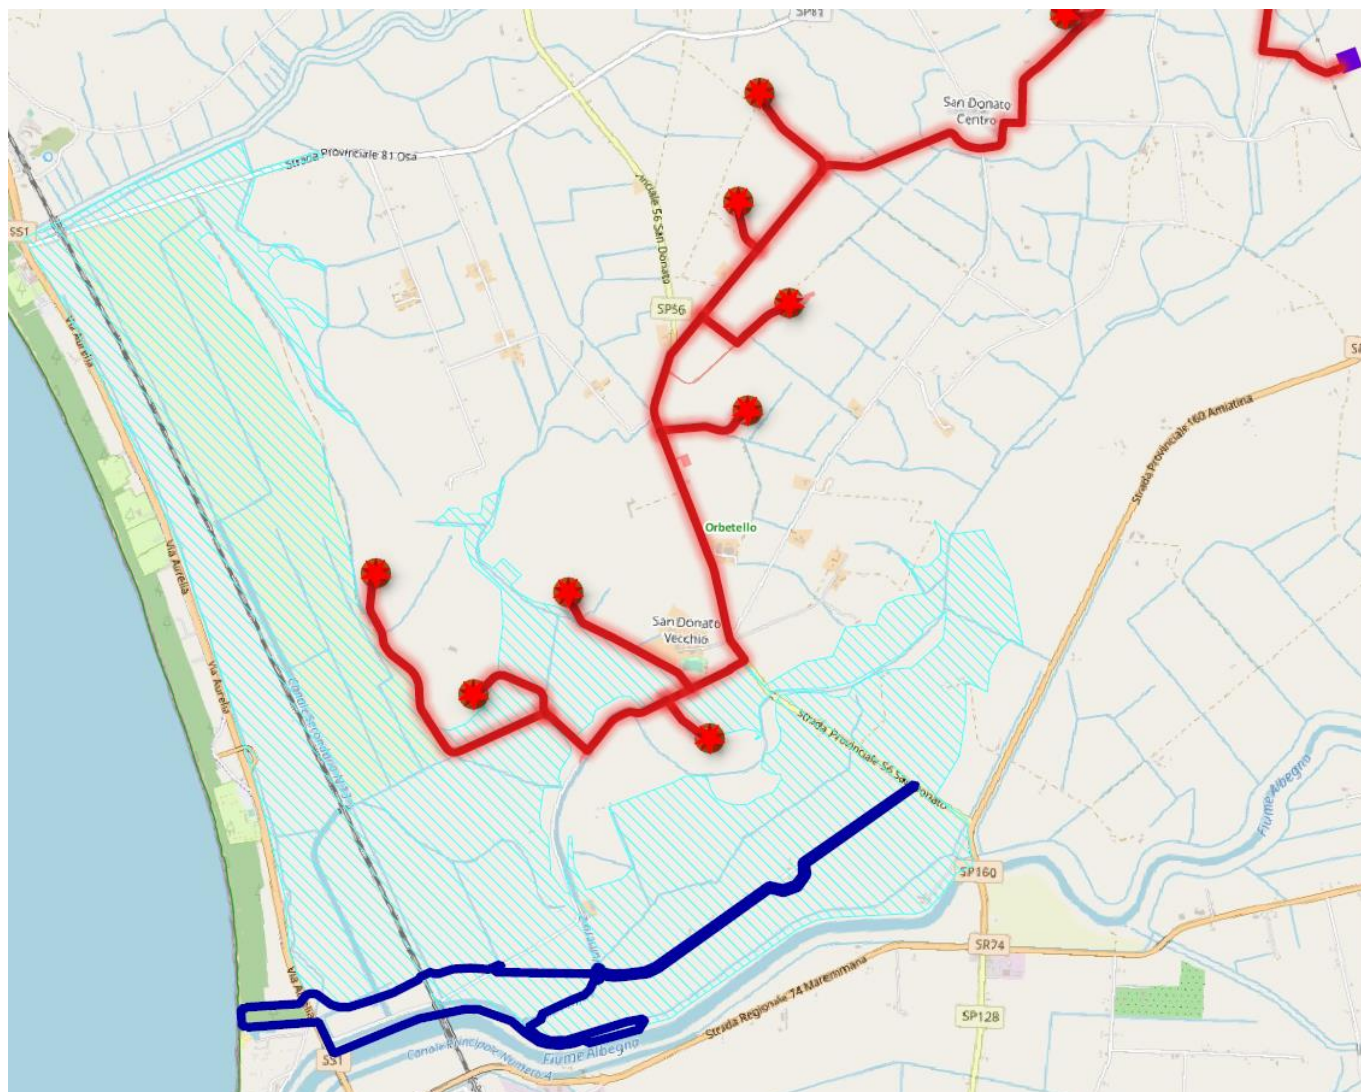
Raffronto tra la planimetria di progetto dell'impianto eolico e la cassa di espansione
